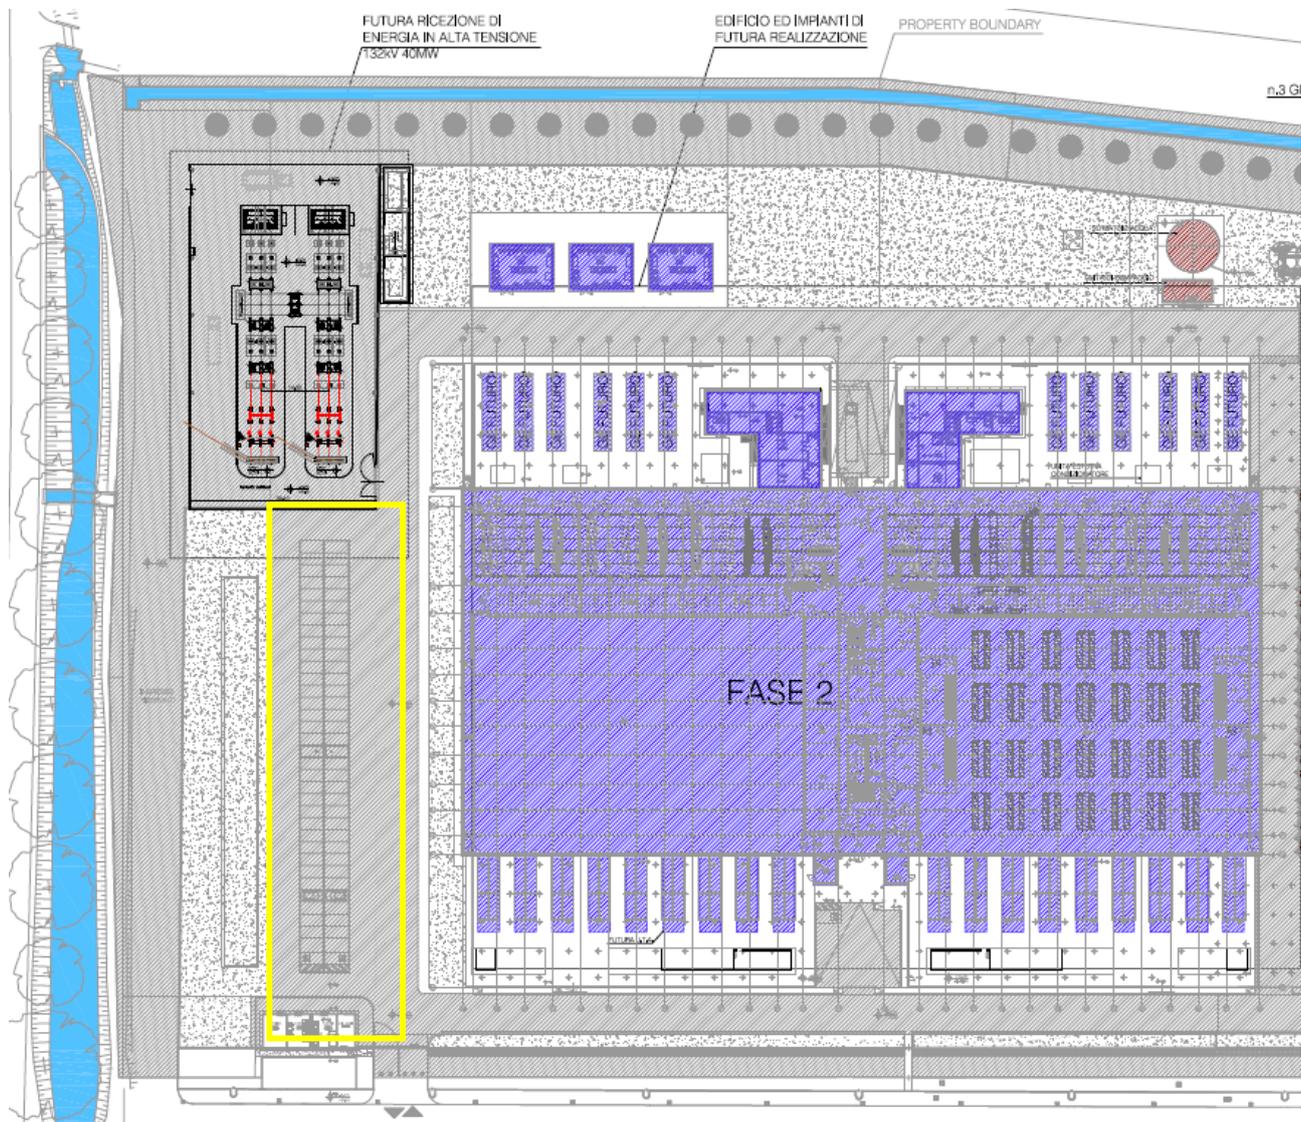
estratto da "EE001 – Planimetria dell'Officina Elettrica" con dettaglio mod. 2 (impianto fotovoltaico in giallo)
